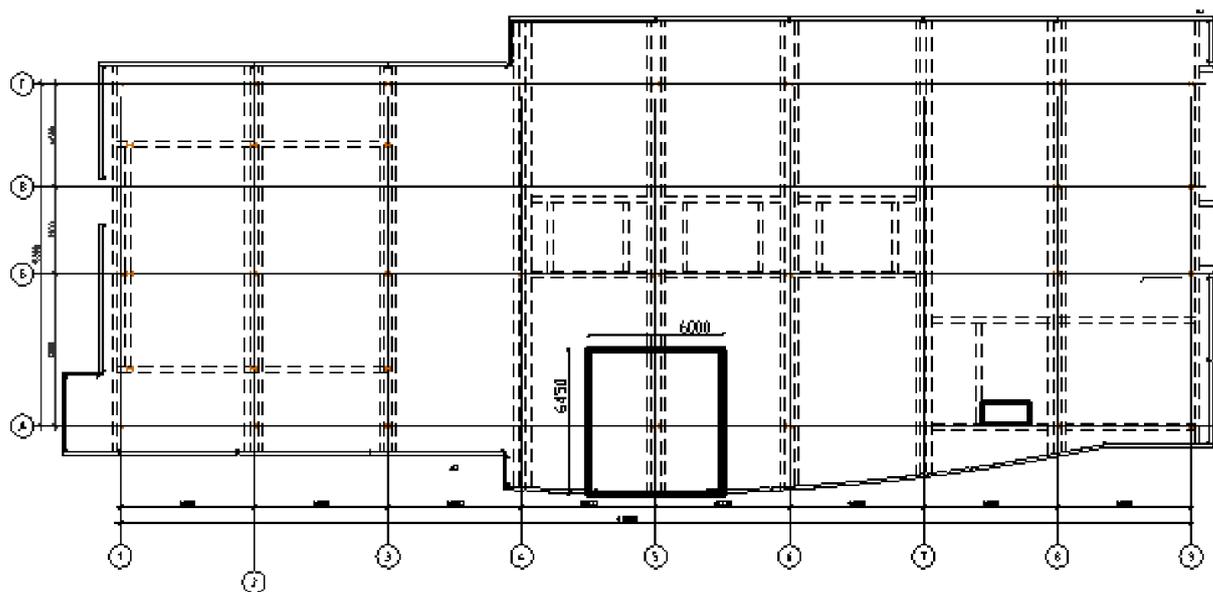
Грузовые площади фундамента на отм. 9,800 по оси А-5.
